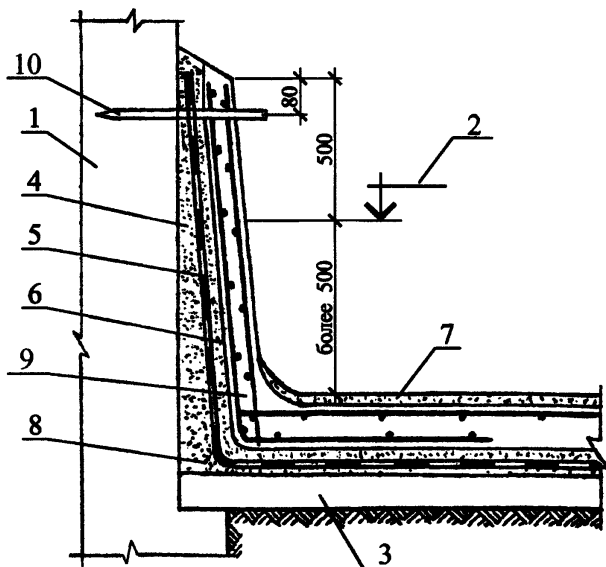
Гидроизоляция реконструируемых подвалов по существующему бетонному полу, при уровне грунтовых вод более 50 см (вариант армирования сварными сетками)
